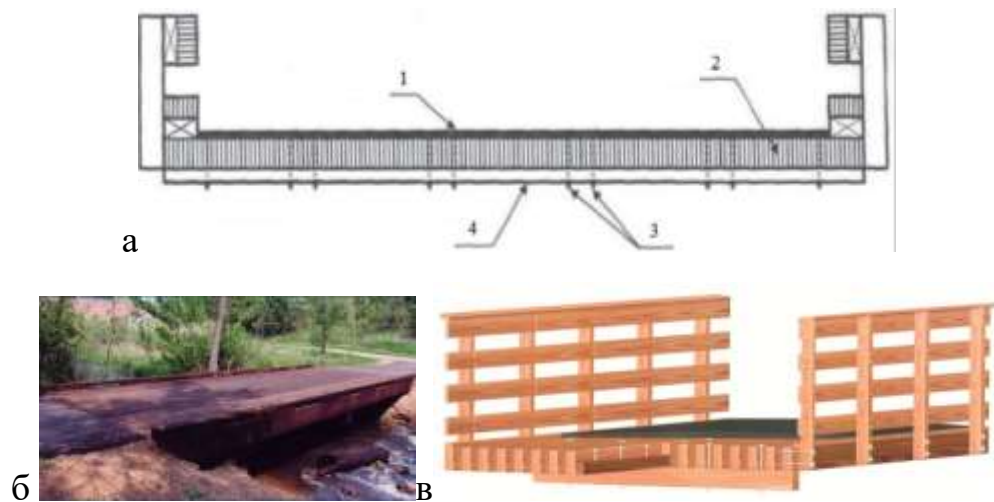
Плитна прогонова будова з клеєної дерево-плити: а – конструкція; б, в – вигляд; 1 – асфальтобетонне покриття; 2 – повздовжня клеєна дерево-плита; 3 – з'єднувальні болти; 4 – поперечна балка для розподілу навантаження
